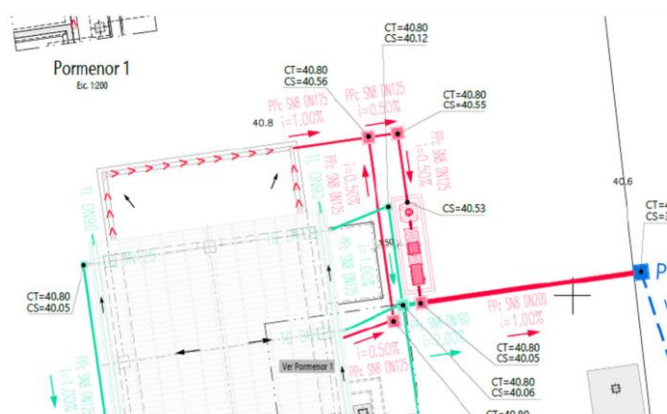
Rede a vermelho correspondente às escorrências da zona de descargas dos camiões. (Fonte: Elementos Adicionais do EIA).
